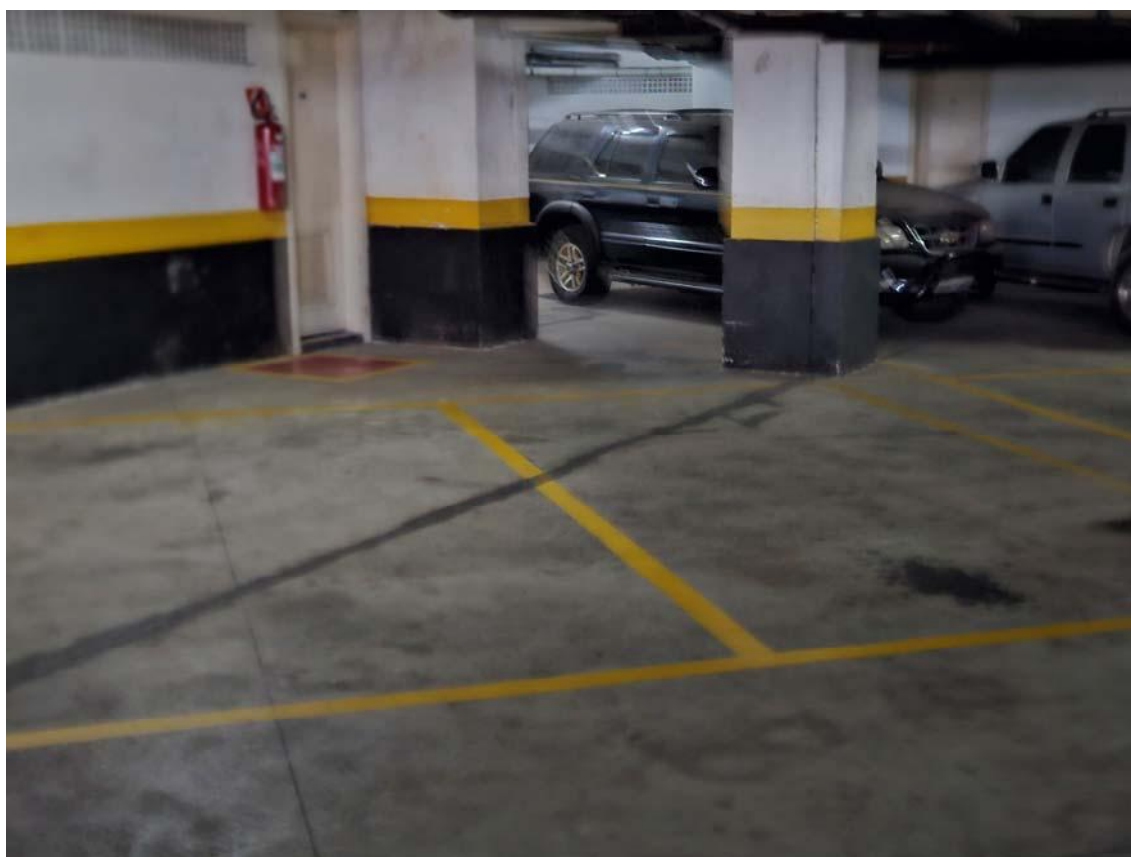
OUTRA 2 VAGAS DE GARAGEM DO APARTAMENTO.
